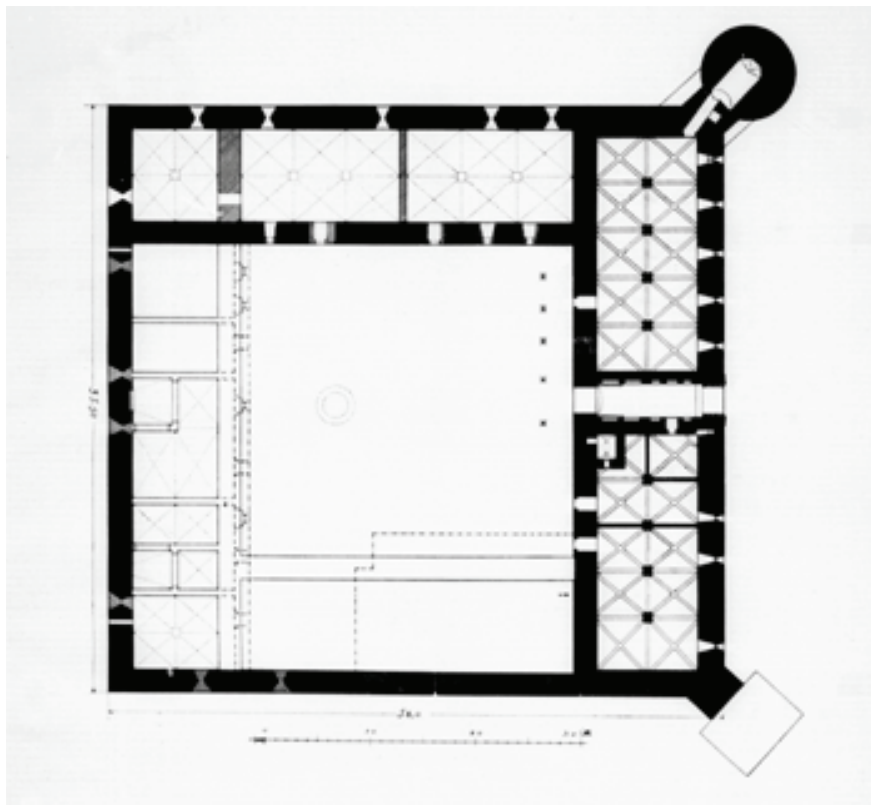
Burg Barten, Erdgeschoss, Grundriss nach C. Steinbrecht.
